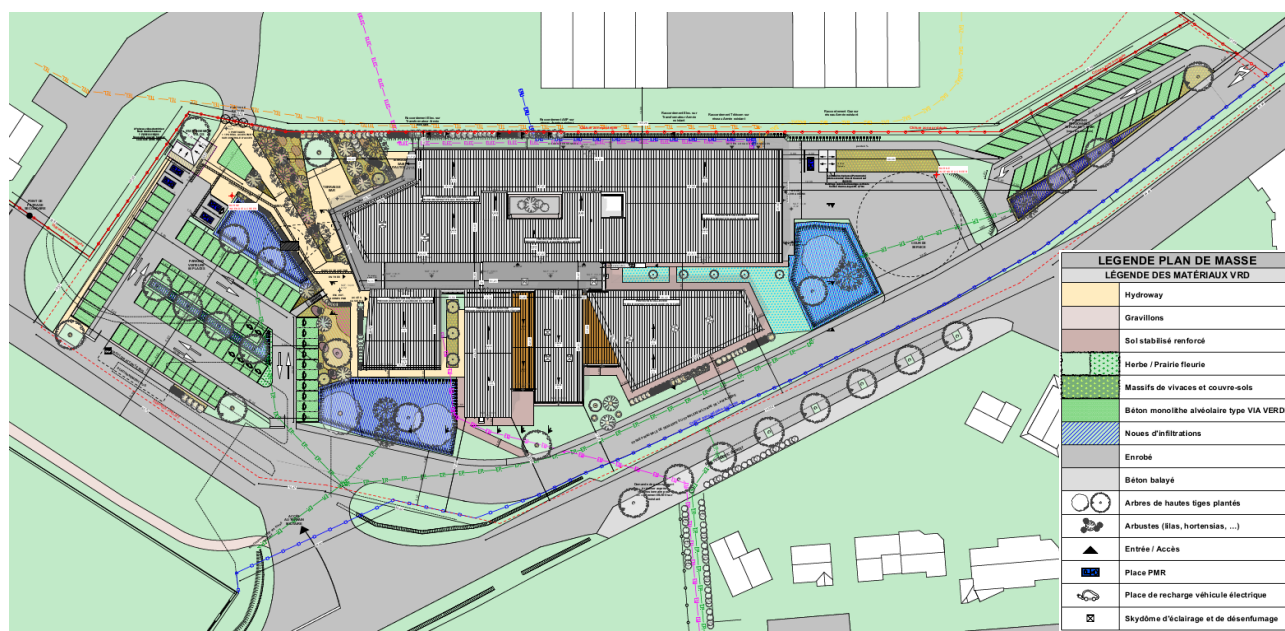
PLAN DE MASSE (SOURCE : CRR)
